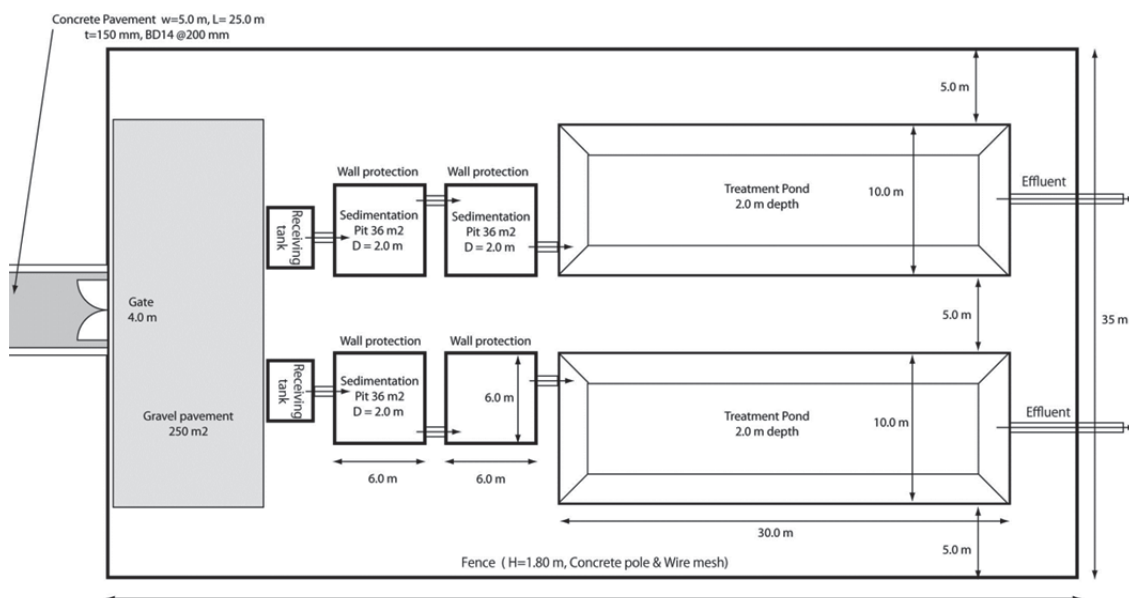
し尿浄化槽汚泥の処理施設の平面図
